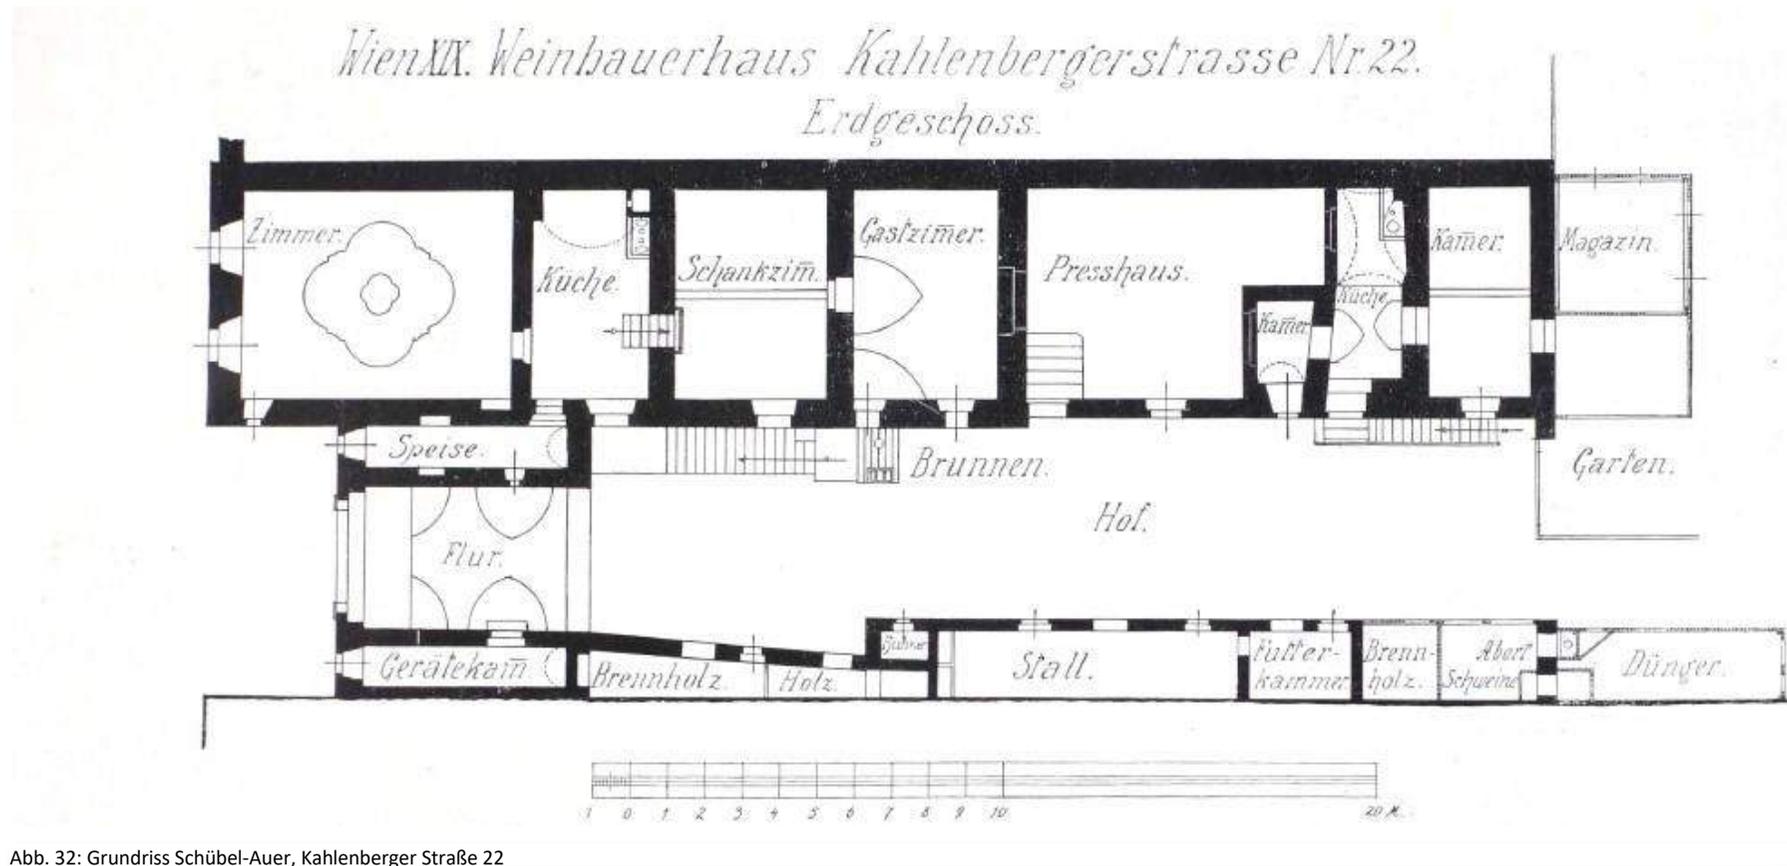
Grundriss Schübel-Auer, Kahlenberger Straße 22
